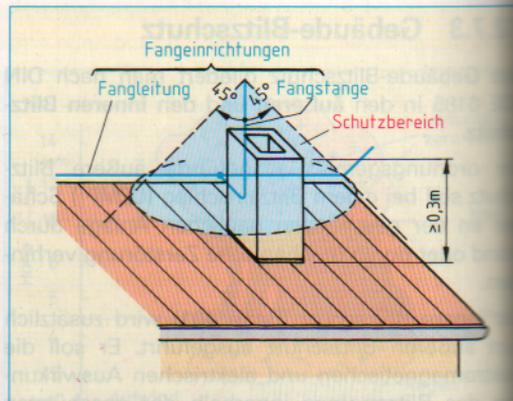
Schutz von Dachaufbauten durch Fangstangen
